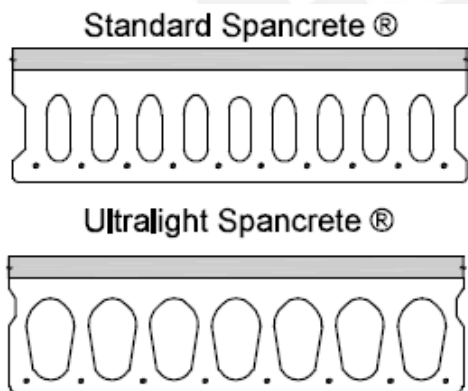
Losa alveolar y capa de compresión. Figura A1.4. Losa alveolar apoyada sobre viga I.
